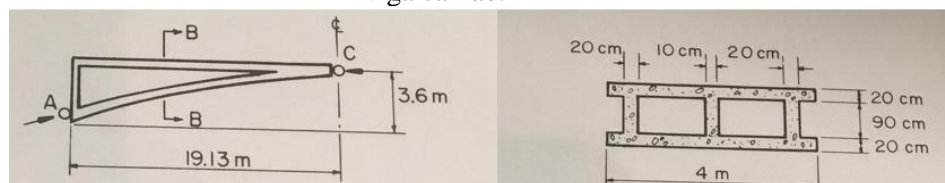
Ponte Stauffacher- representação da fachada em alvenaria, arco de concreto, articulações, paredes transversais e tabuleiro
